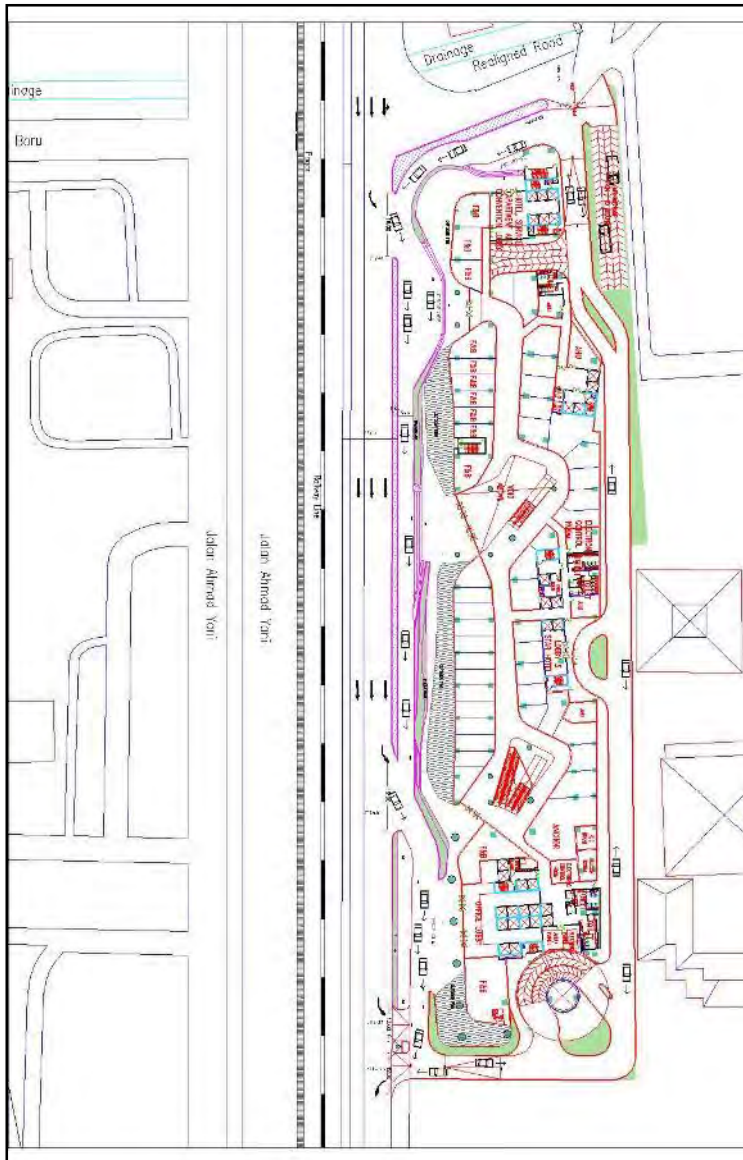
Denah Jaringan Jalan Superblock The Frontage Surabaya
